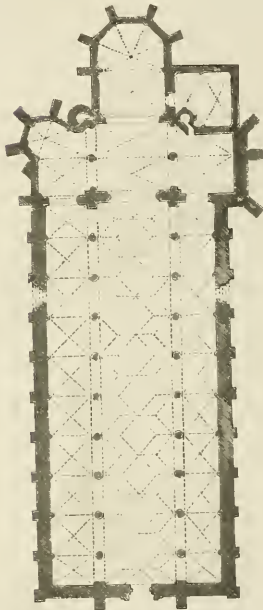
St. Georg zu Hagenau. Grundriss.
